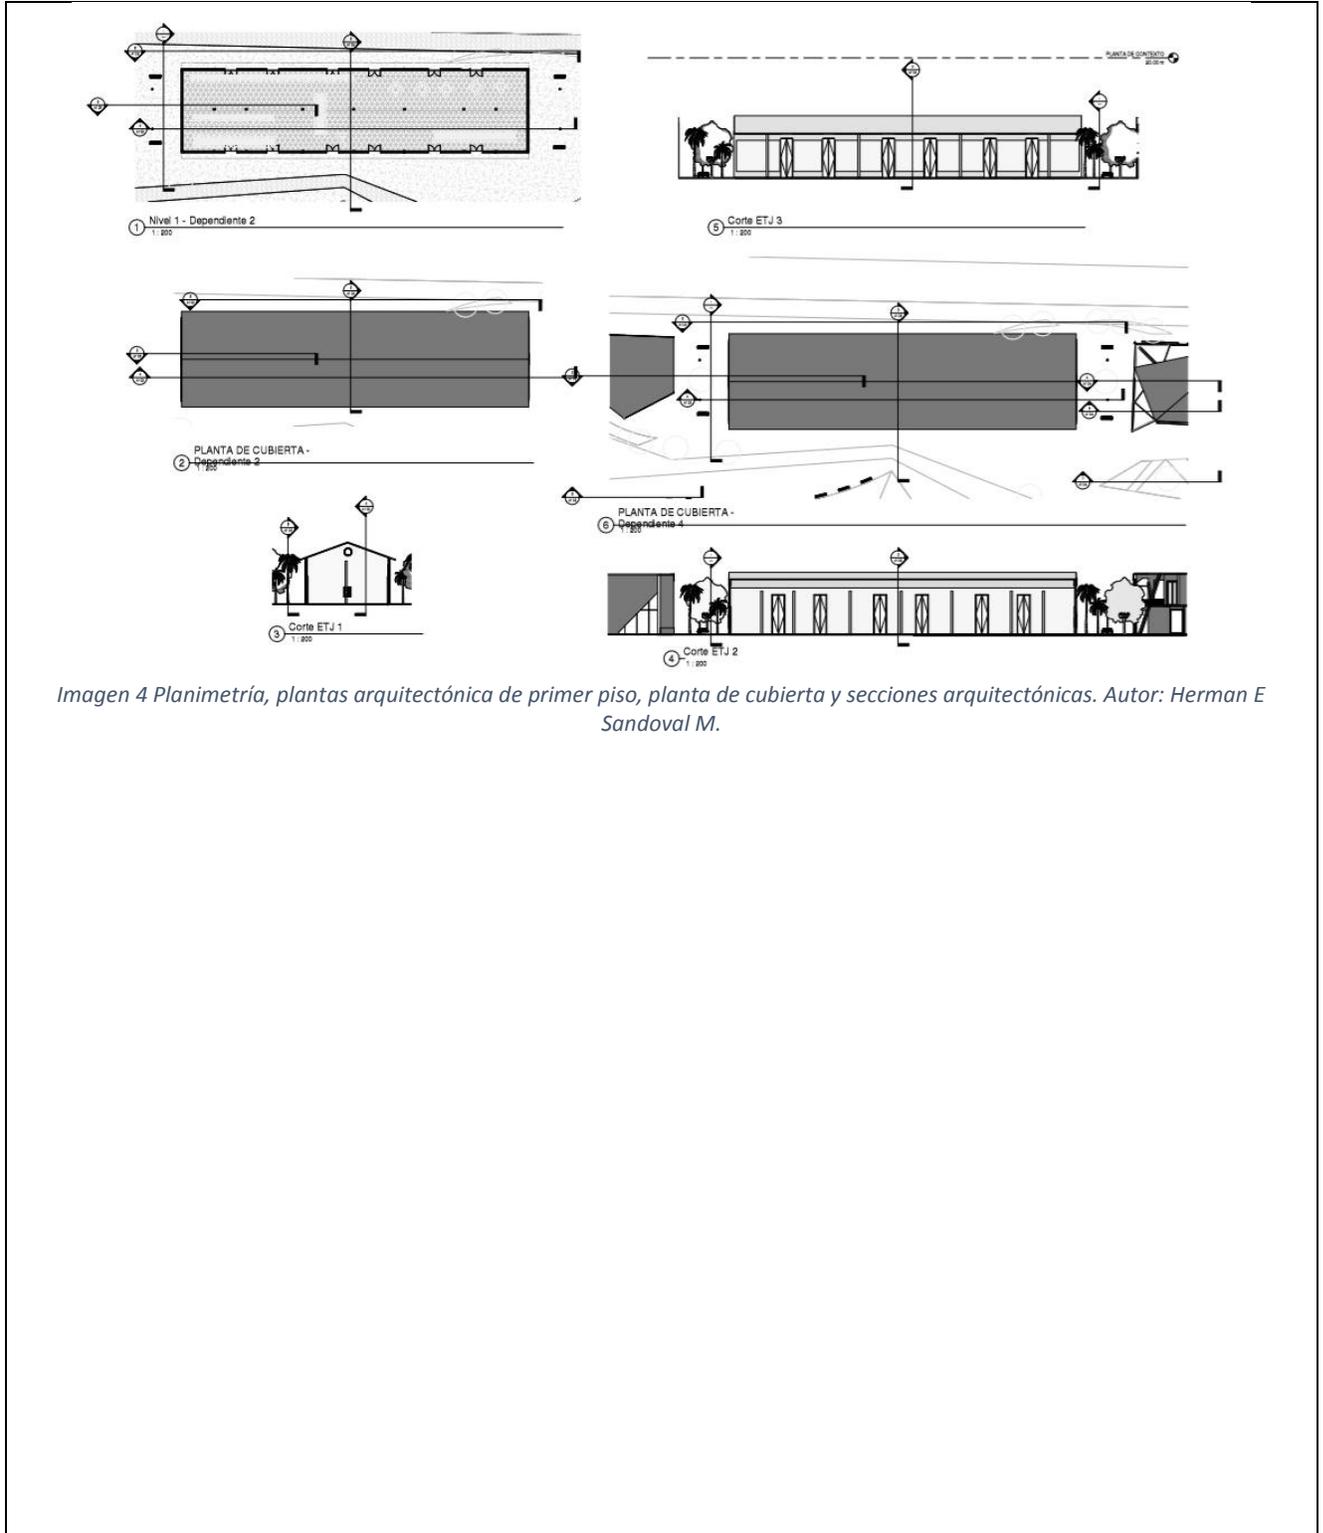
Planimetría, plantas arquitectónica de primer piso, planta de cubierta y secciones arquitectónicas. Autor: Herman E Sandoval M.
